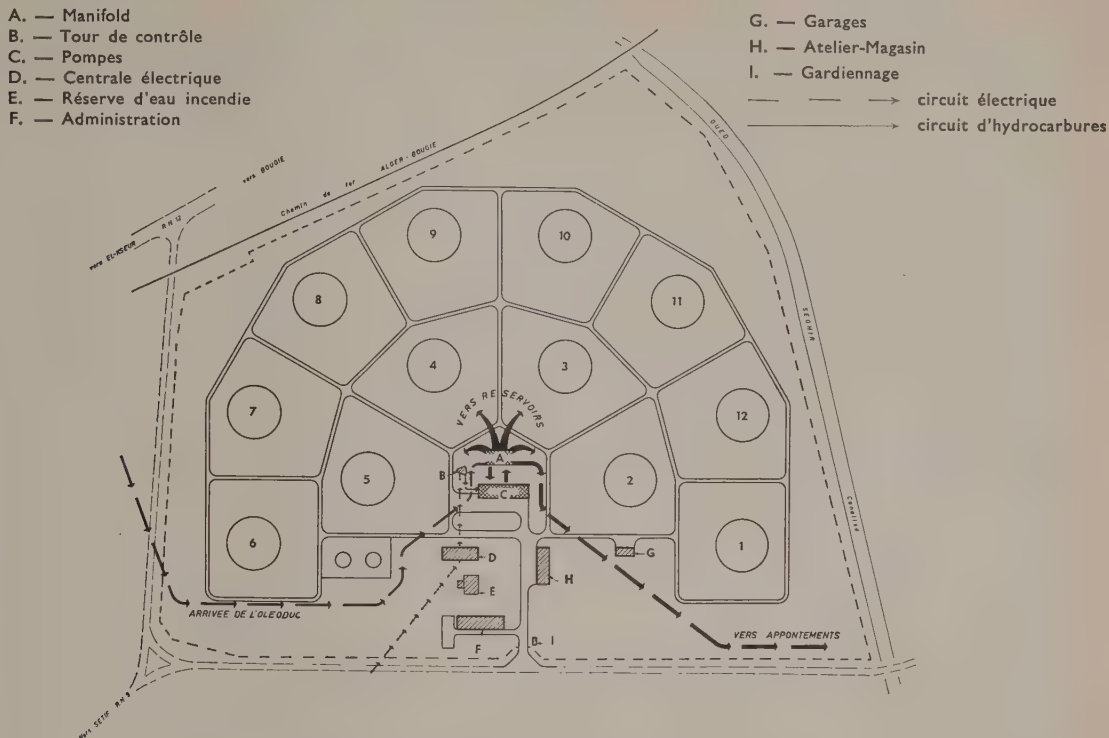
Oléoduc Hassi-Messaoud-Bougie — Terminal marin.
